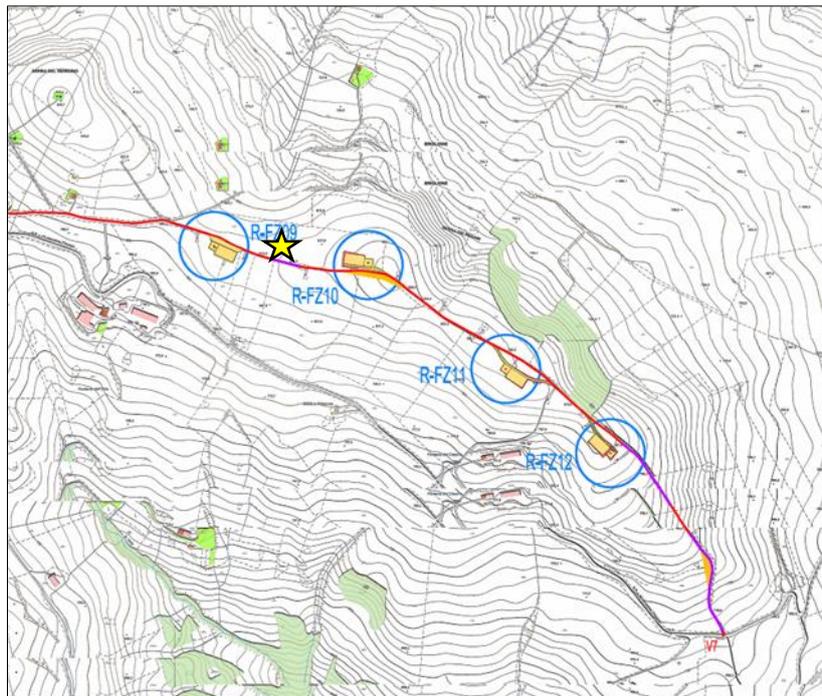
Area sud - Ubicazione area di cantiere★
